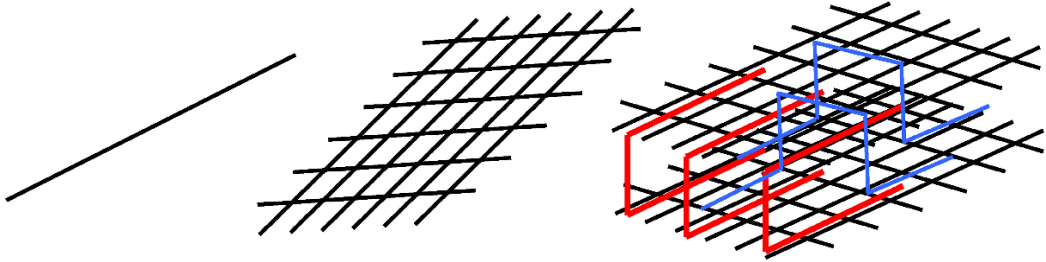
Das ein-, zwei- und dreidimensionale Geflecht aus den ein-, zwei- und dreidimensionalen Betonstahlpositionen.
